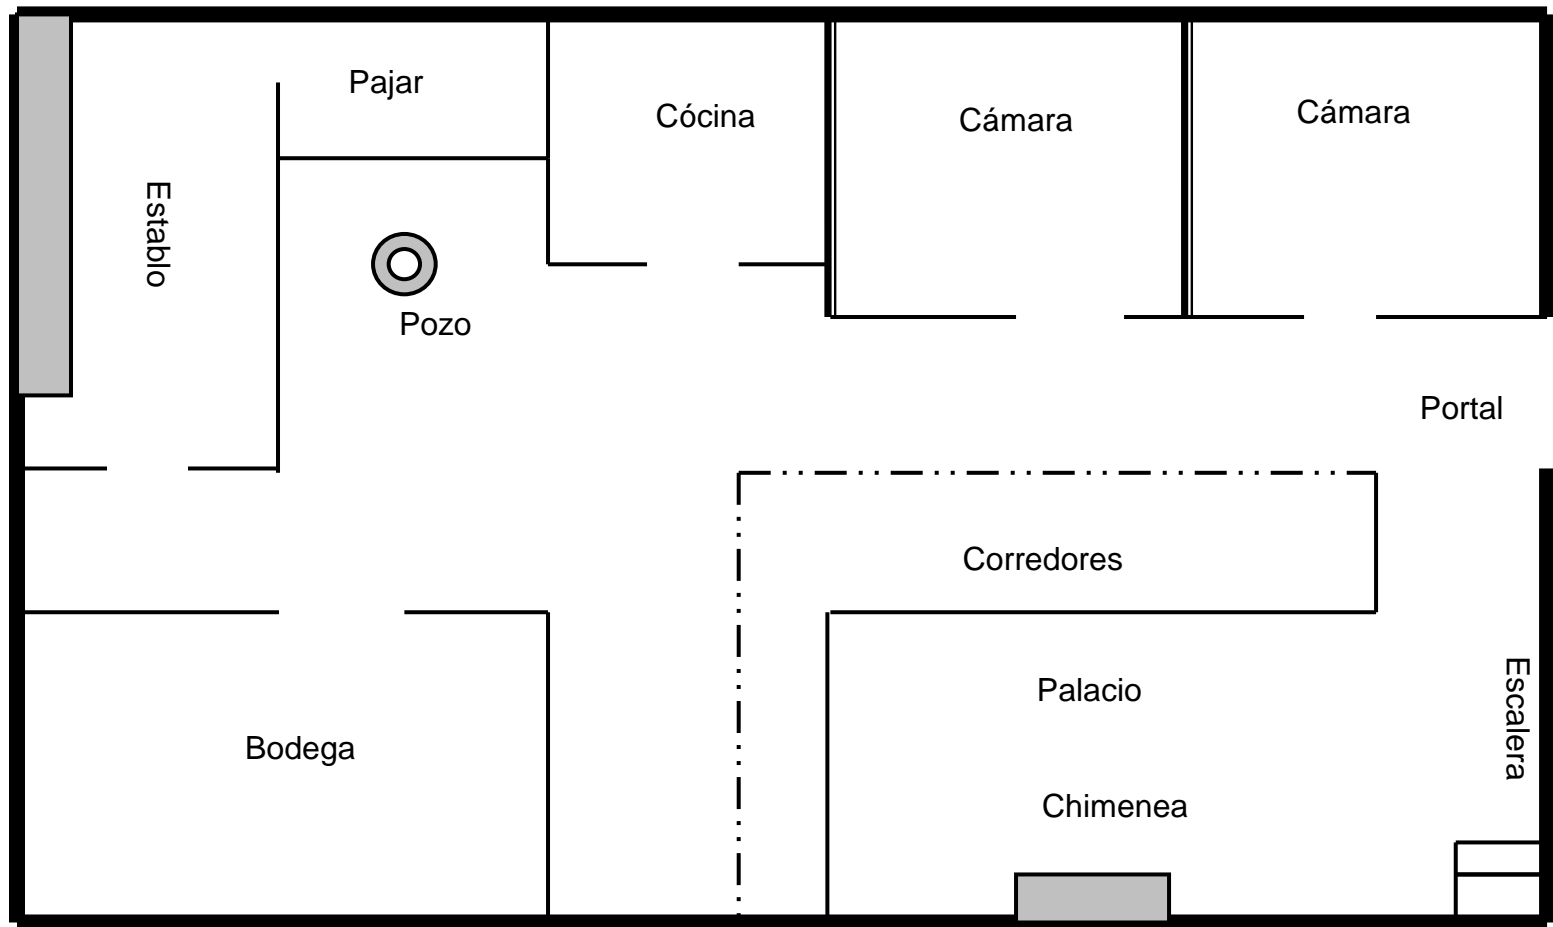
Recreación plano casa de planta baja de dimensiones medias.
